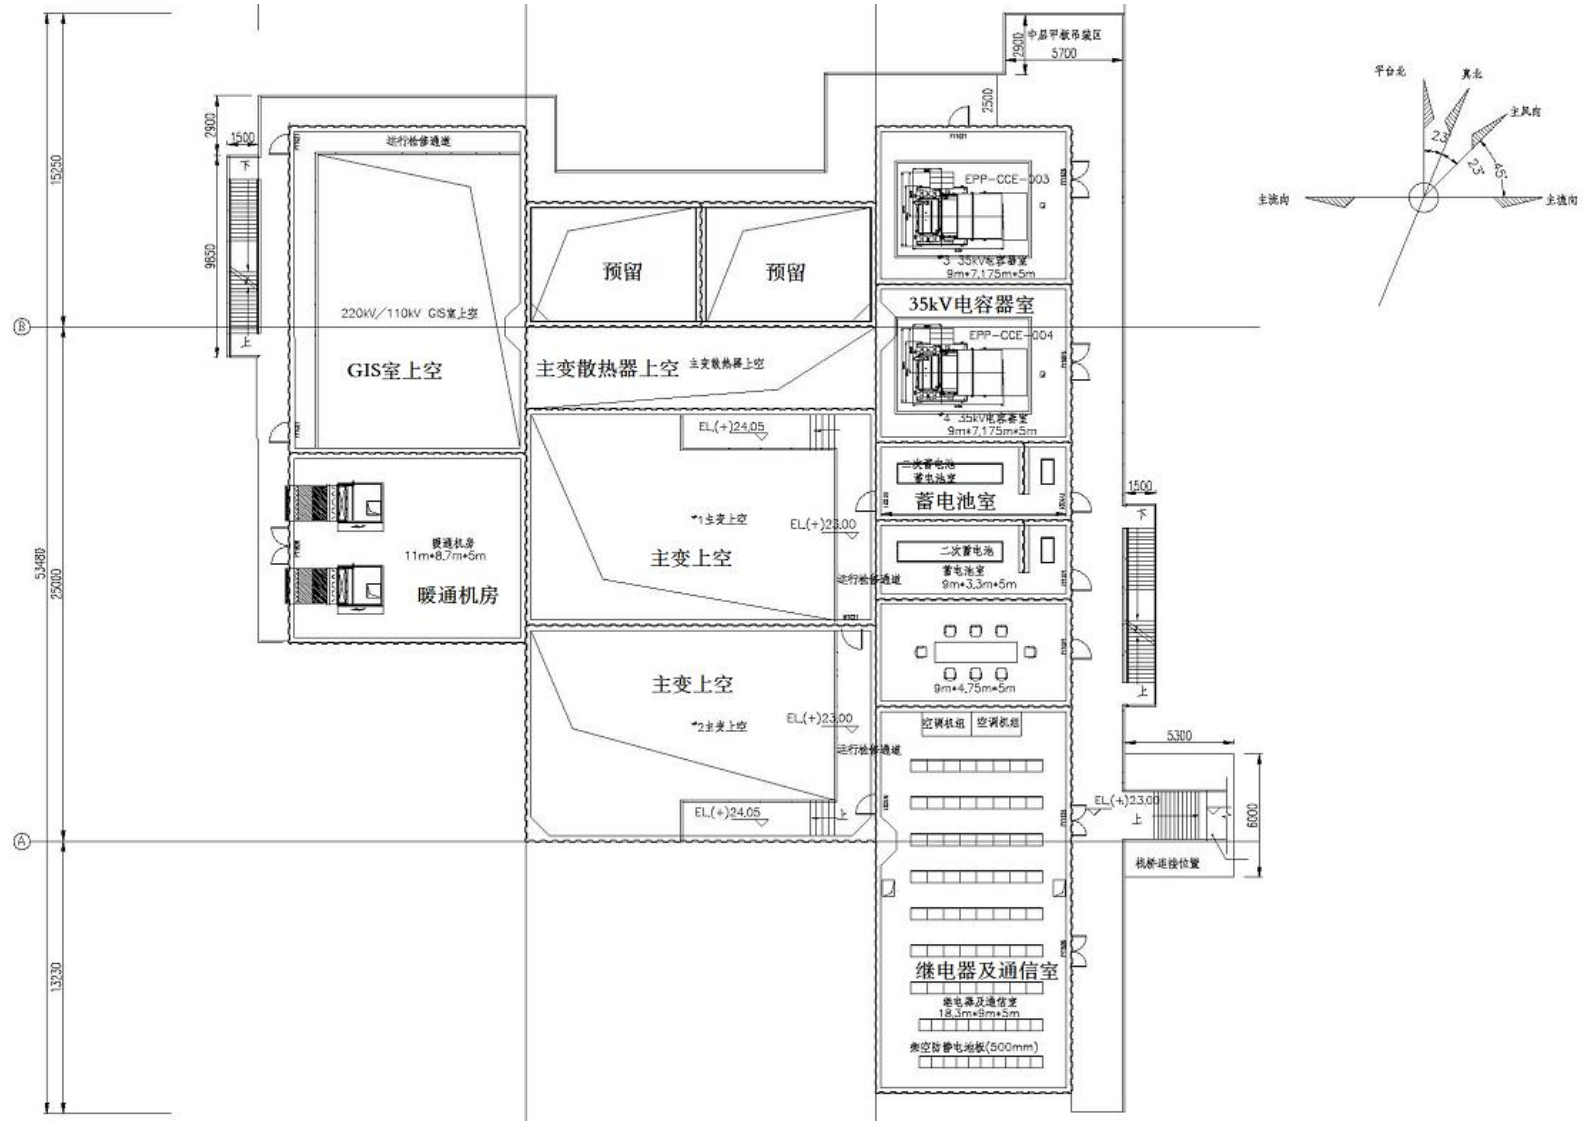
QHD32-6 EPP 平台中层甲板平面布置图
